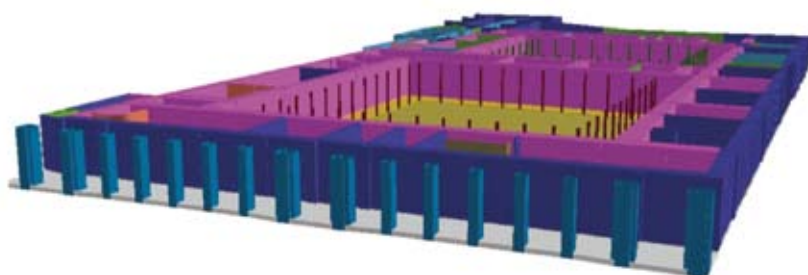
MODELO DE MUROS SEGÚN MATERIAL & VALOR & ESTADO EN LA PLANTA BAJA. ARCHIVOS PROYECTO *virCPM*, JUNIO 2011.
